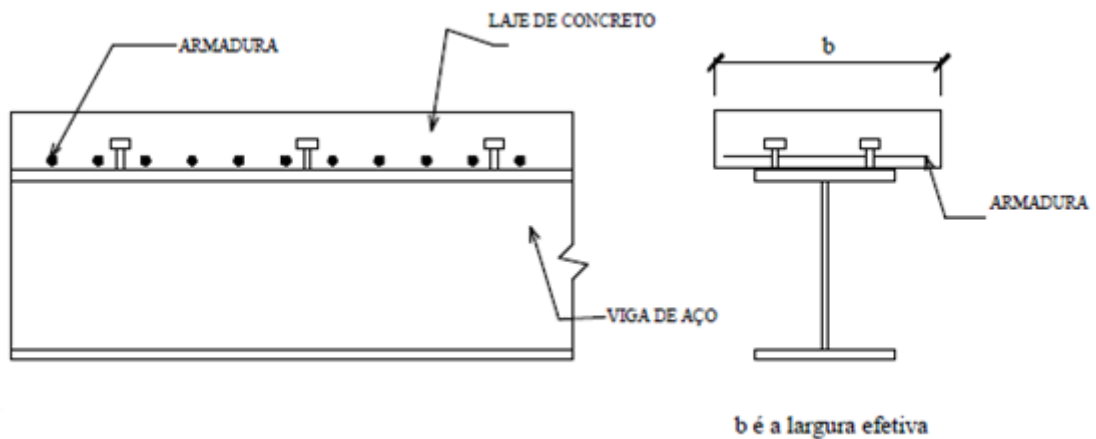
Disposição das armaduras transversais (adicionais) na laje de concreto
